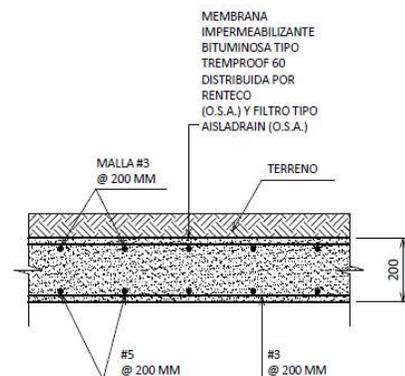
Detalle de muros colados en sótano. Fuente: constructora.
